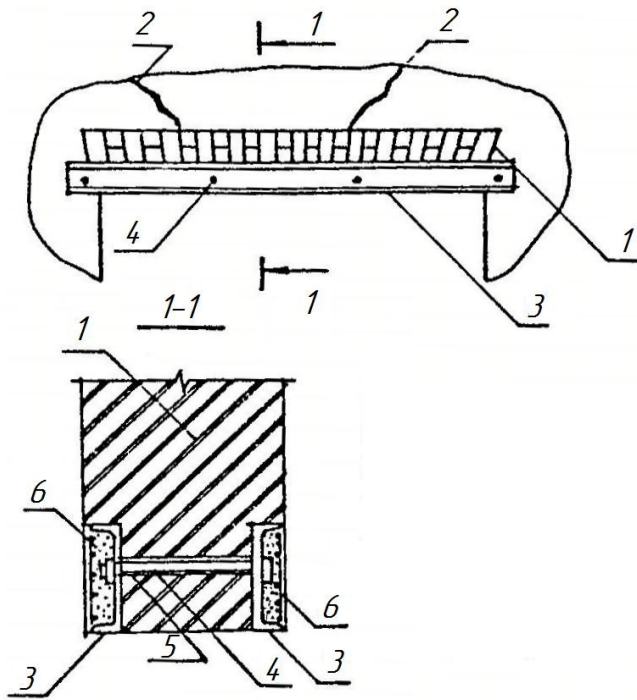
Встановлення накладок на стяжних болтах: 1 – посилювана перемичка; 2 – тріщини в перемичці; 3 – накладки зі швелера; 4 – стяжні болти; 5 - отвори в стінці; 6 – штукатурка по сітці
